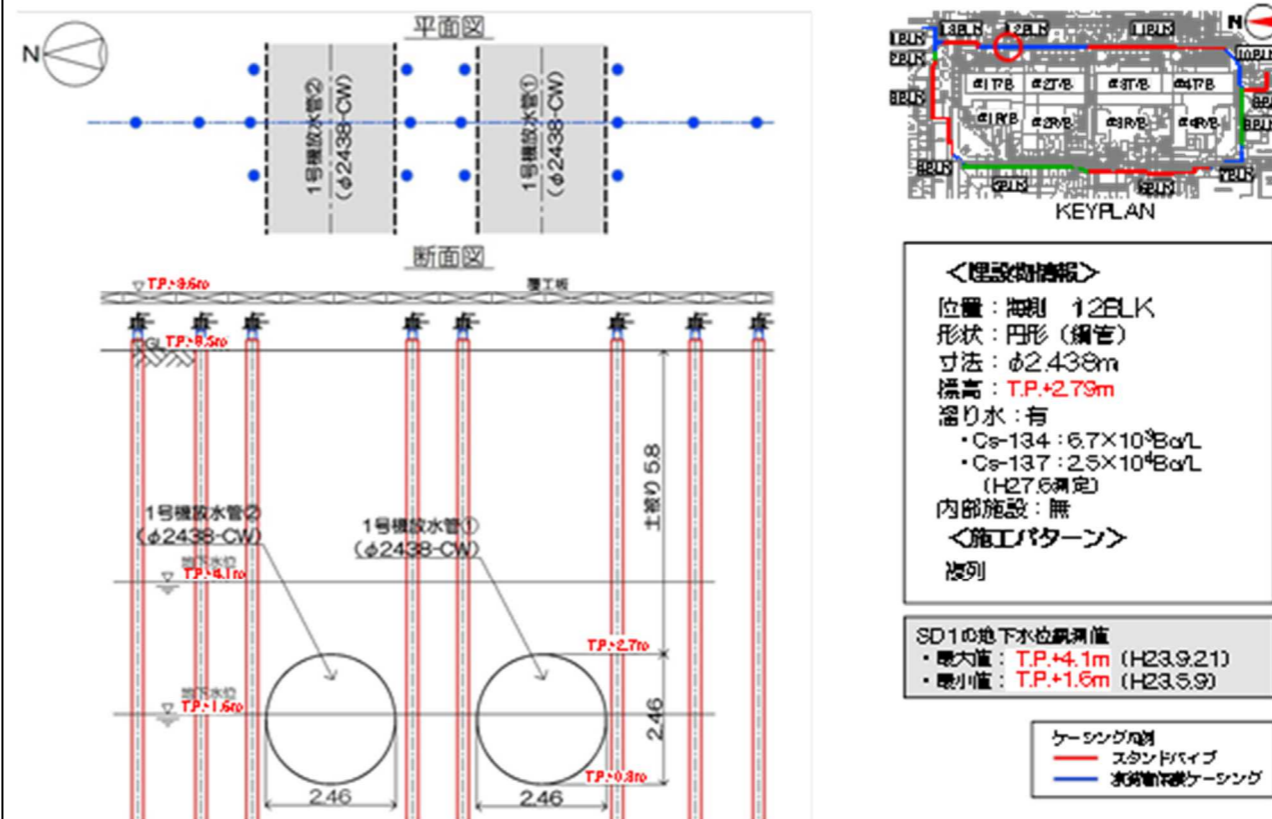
【12-7】1号機放水管①② 施工方法 (複列施工)
